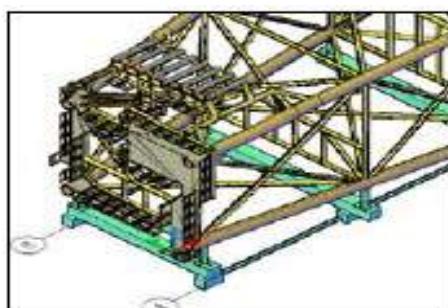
Assembly Diagonal brace Elevation ROW A
